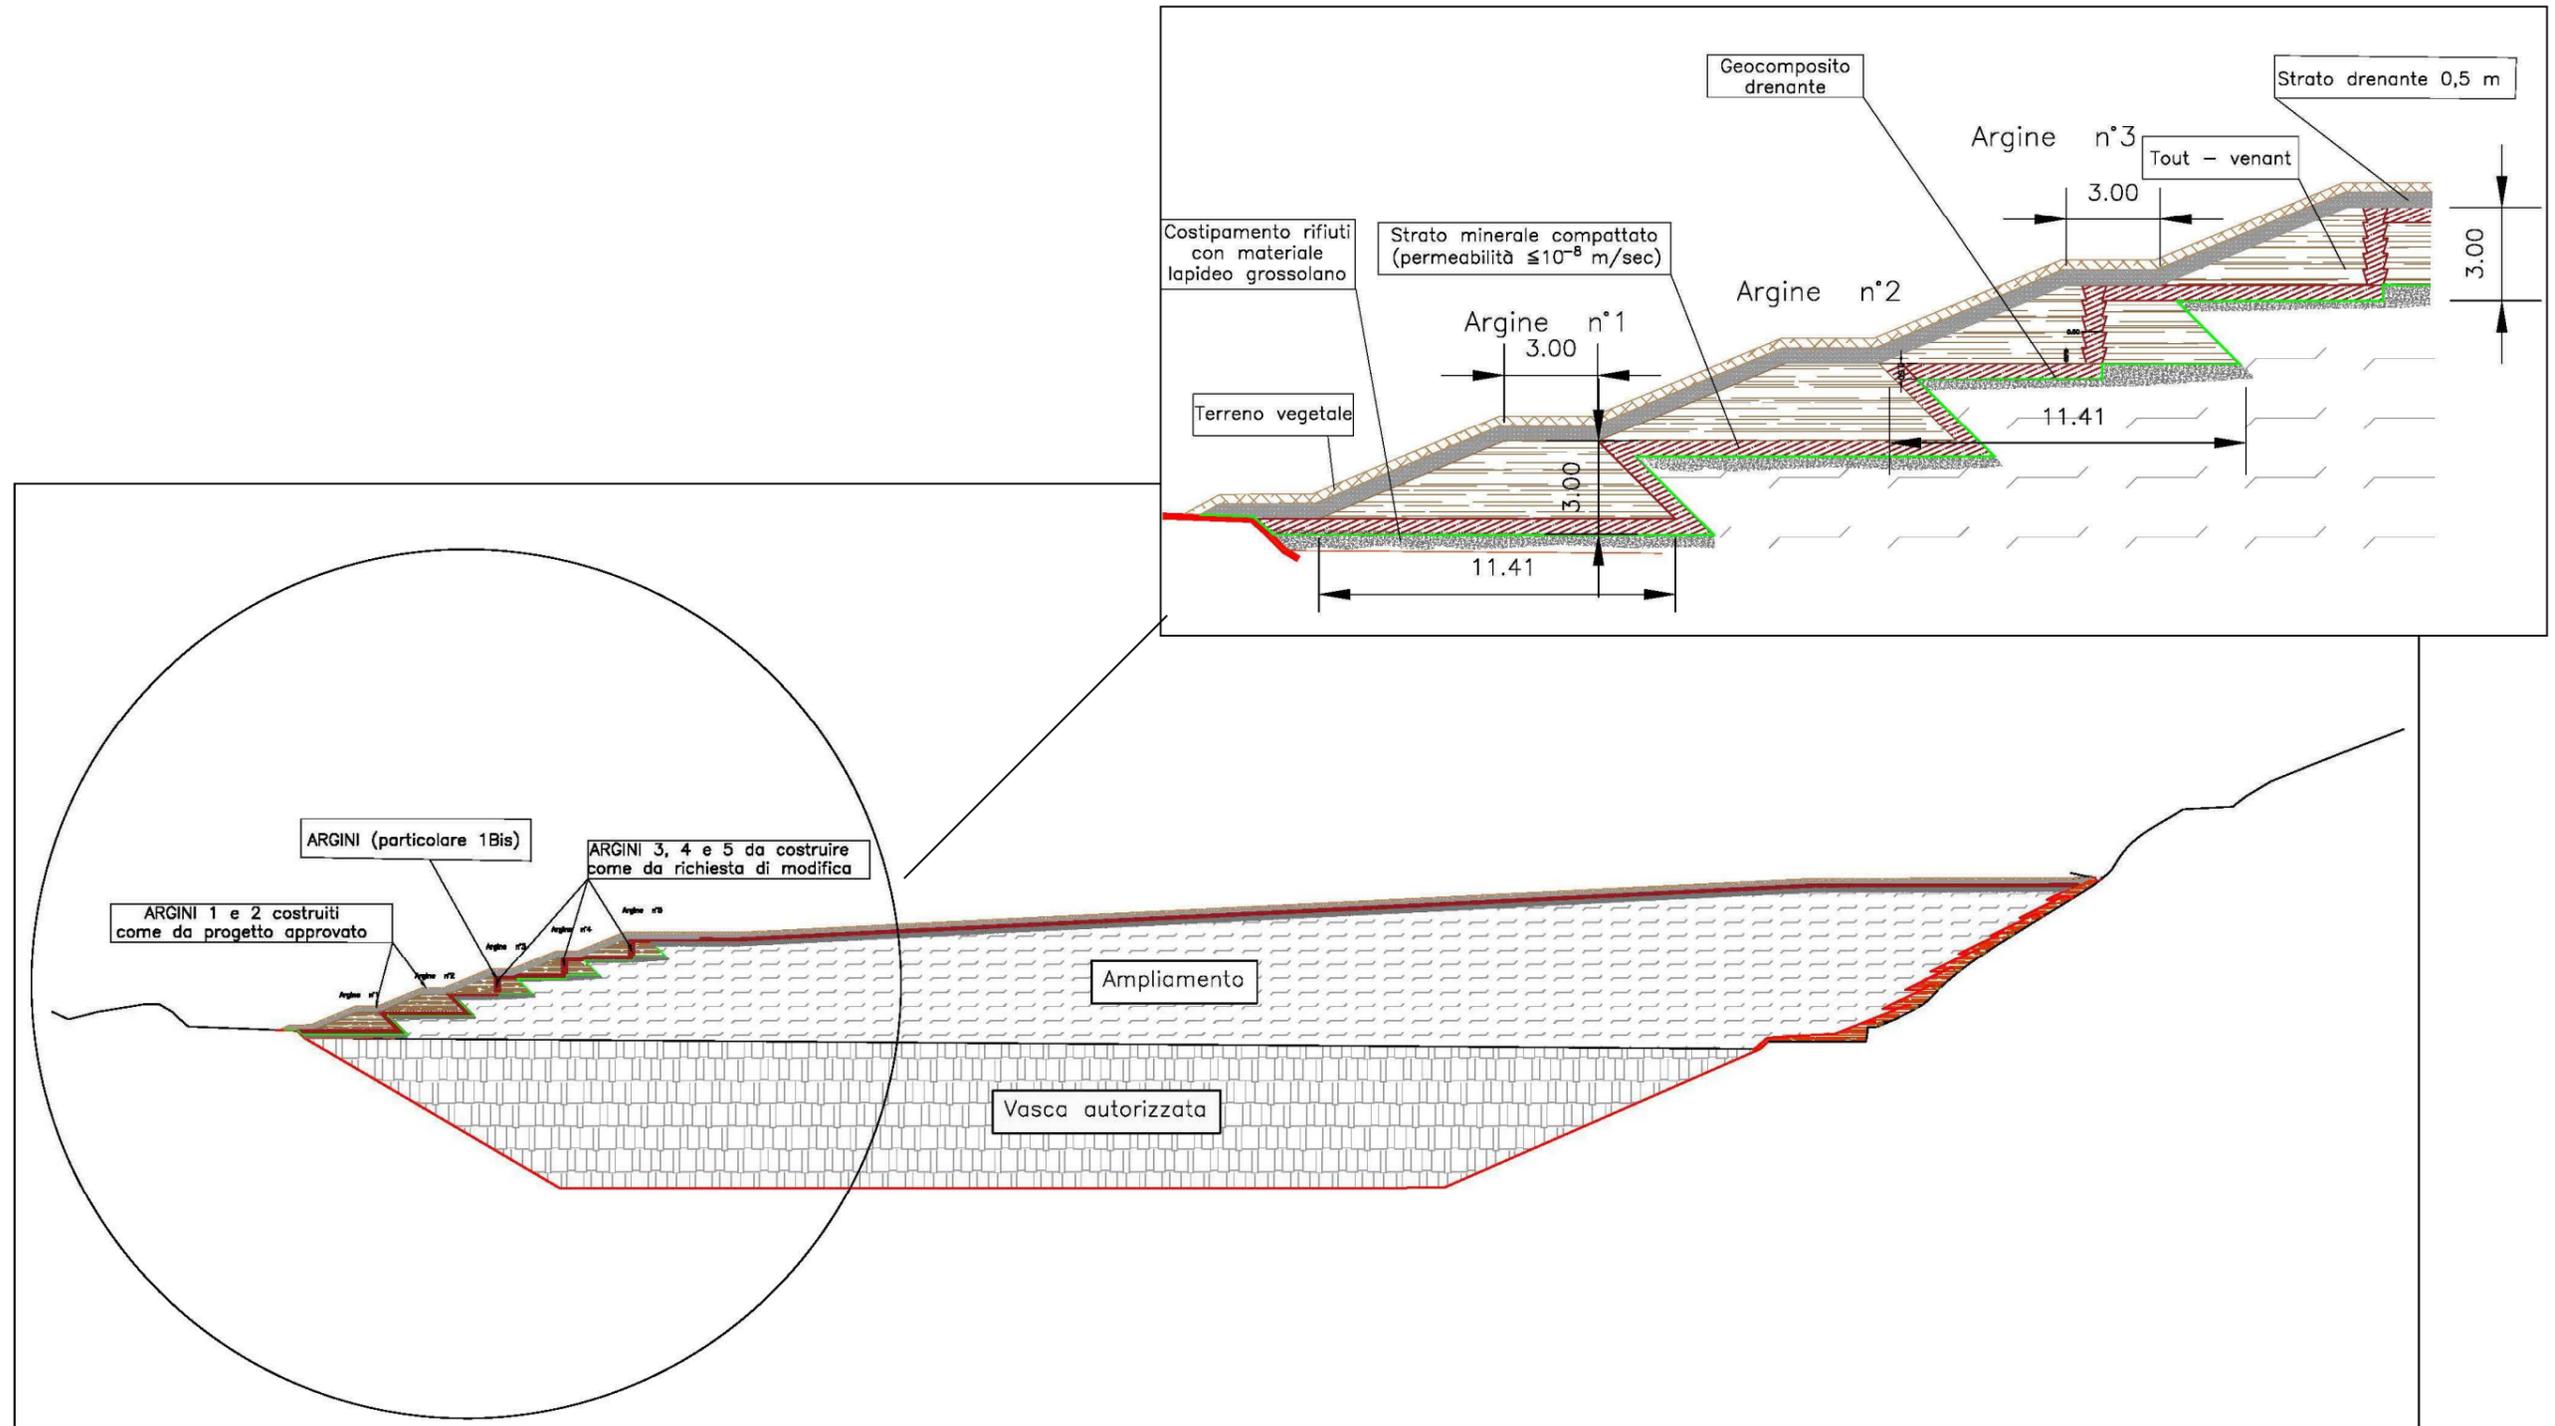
/III: Sezione tipica e particolare costruttivo argini – Variante proposta per la costruzione del 3°, 4° e 5° argine
